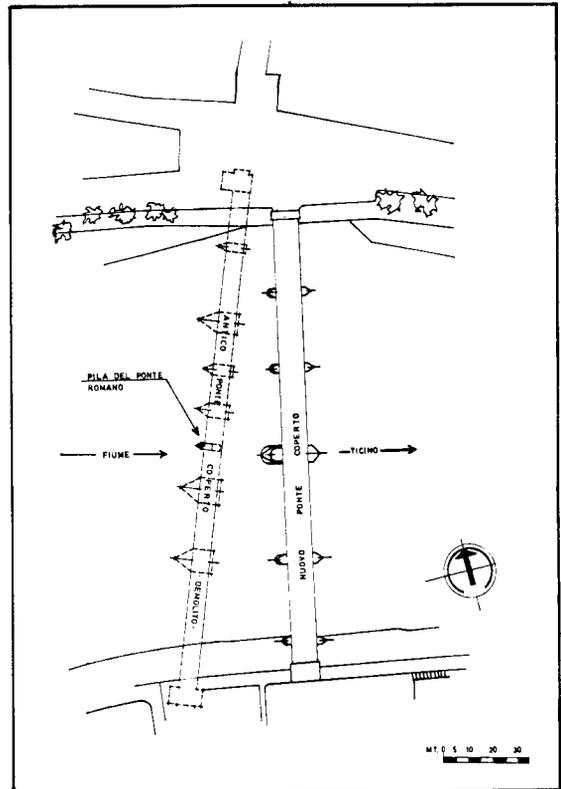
Planimetria dell'attuale ponte coperto e ricostruzione della planimetria del Ponte Vecchio, demolito nel 1948 perché rovinato dai bombardamenti del 5 settembre 1944 (cfr. CALVI, ARECCHI, 1974, Fig. 43).
